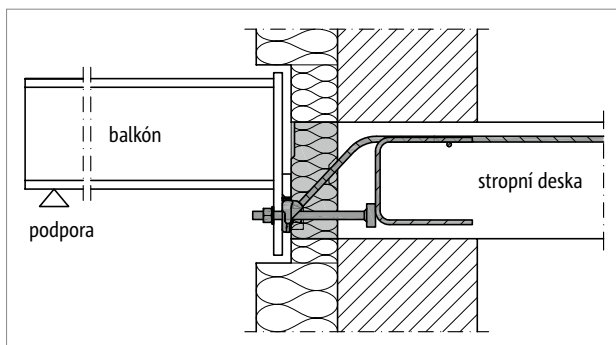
Schöck Isokorb® T typ SQP: Balkón se sloupovými podporami
